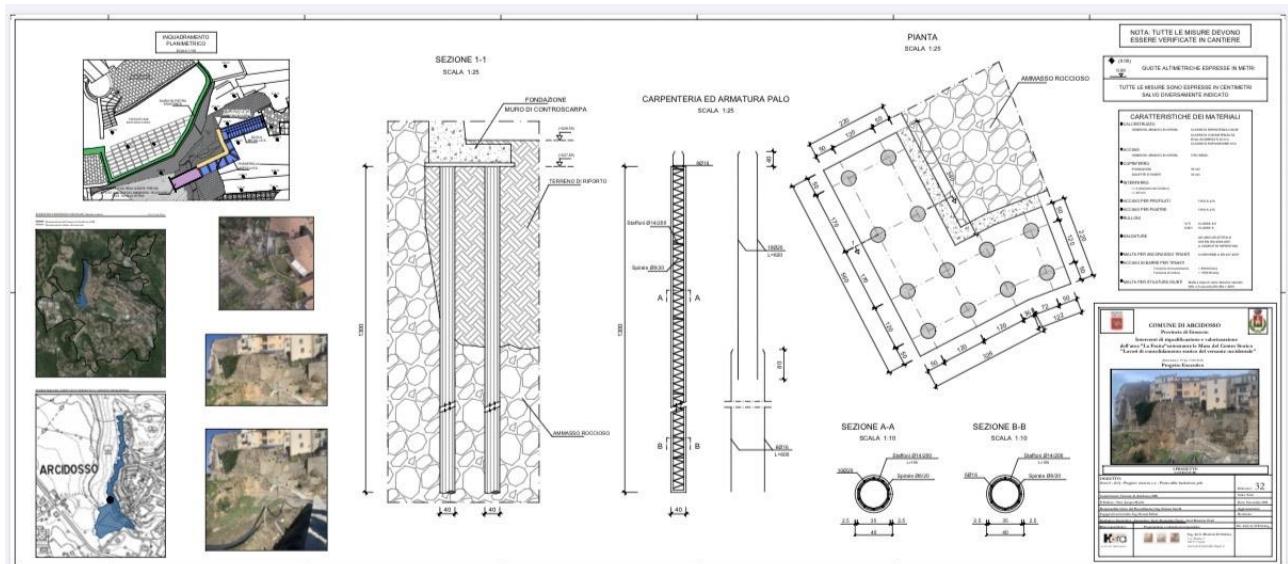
Elab.32 Progetto muro in c.a. - Pianta delle fondazioni con pali
